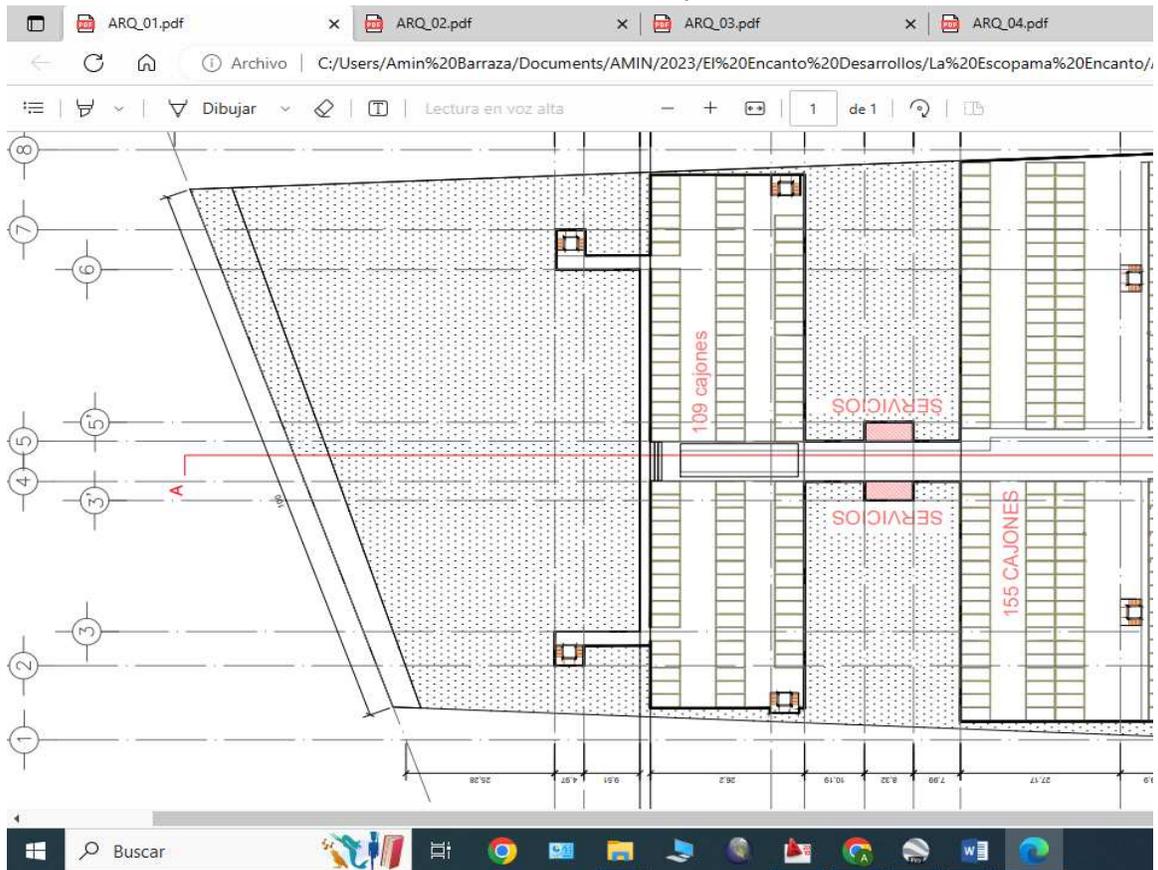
Planta arquitectónica Planta baja. Ver Anexo 4. Plano Arq-02.
